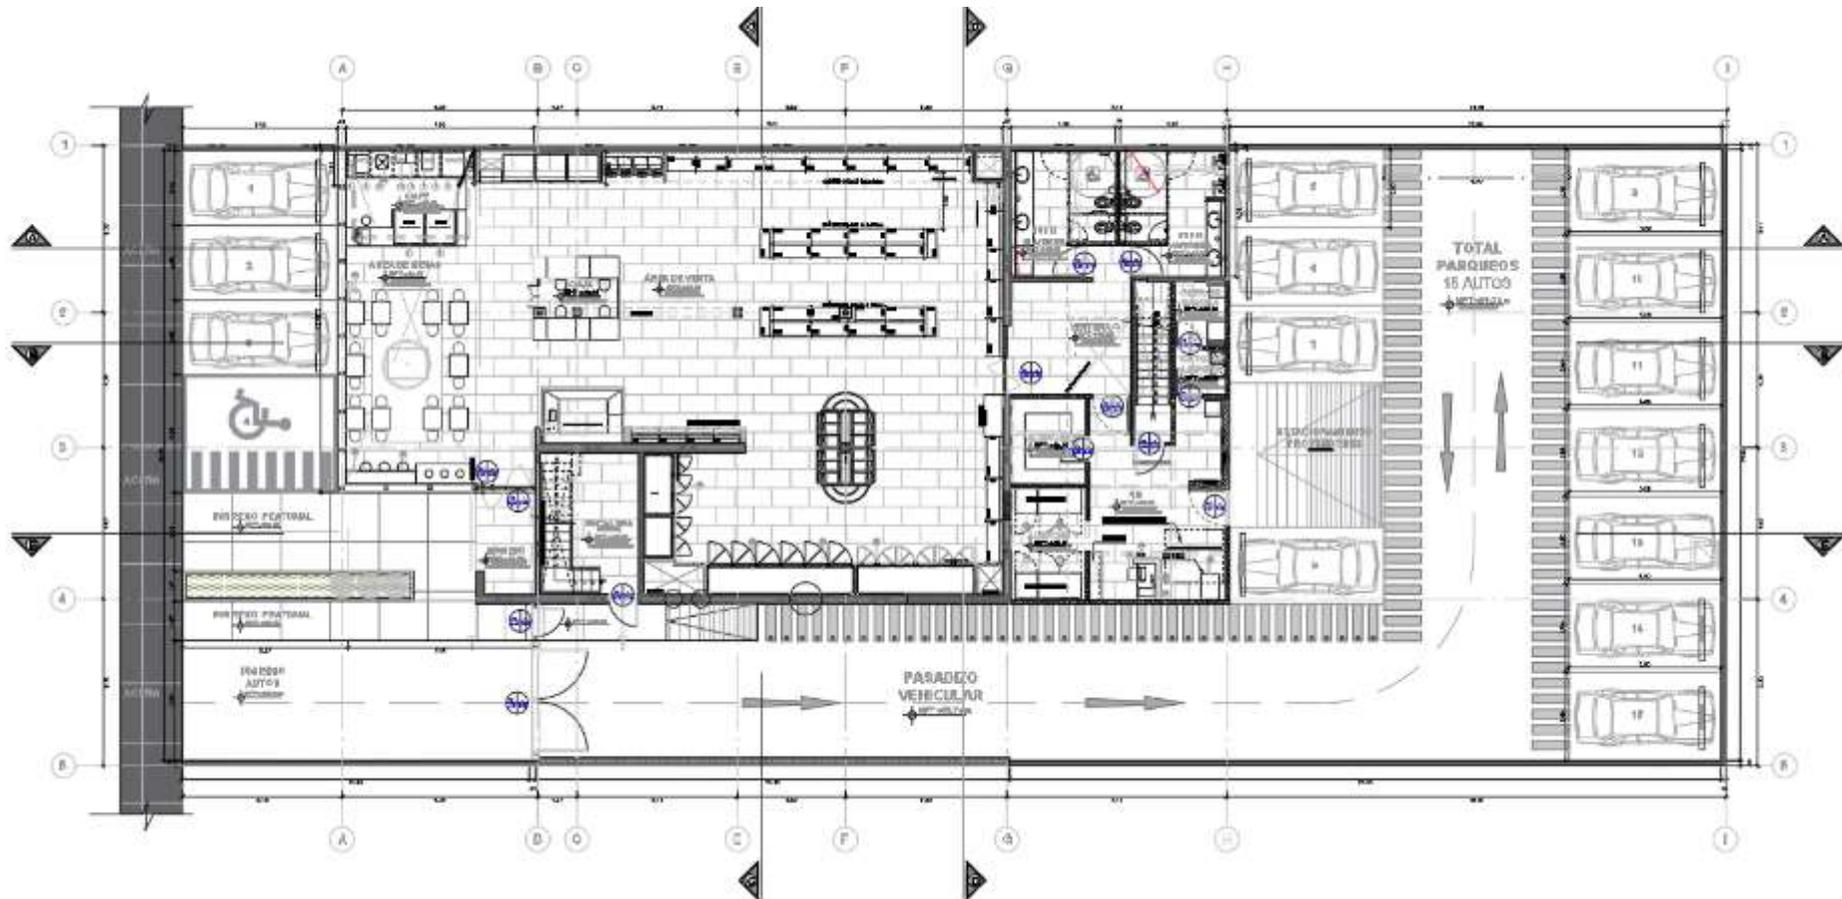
Plano general 1er piso Arquitectura - proyecto Tienda Saludable
